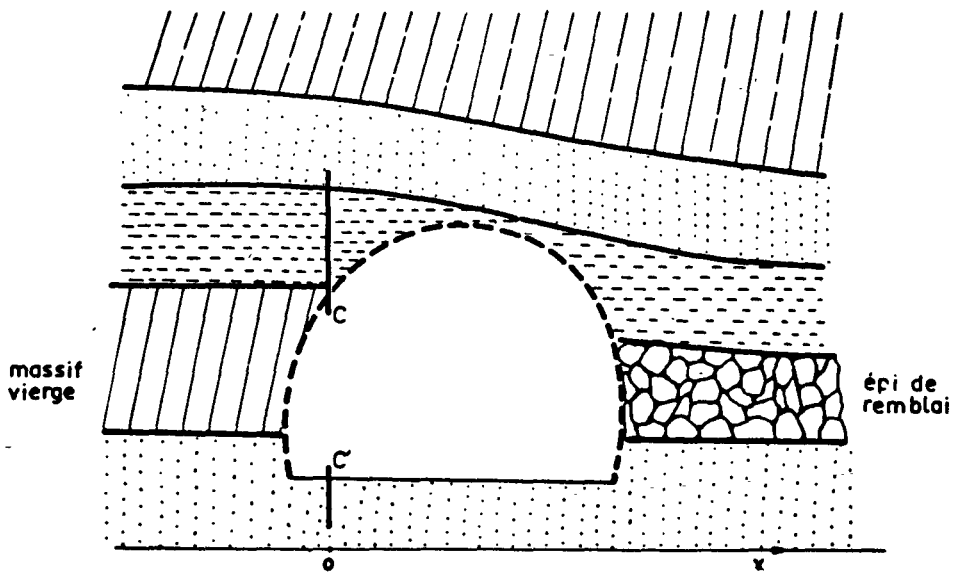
Schématisation de la section transversale d'une voie de taille.
